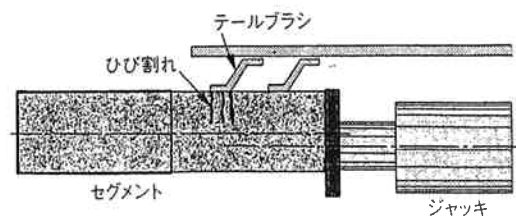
ジャッキ推力の偏心によるひび割れ発生¹⁾
